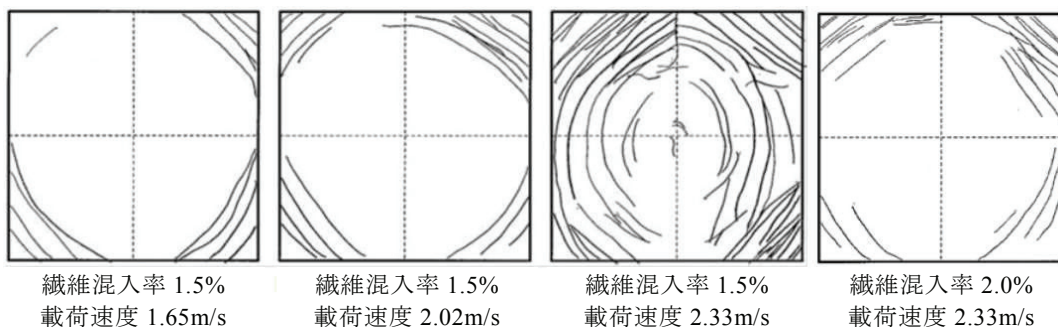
載荷面のひび割れ発生状況 [10]
